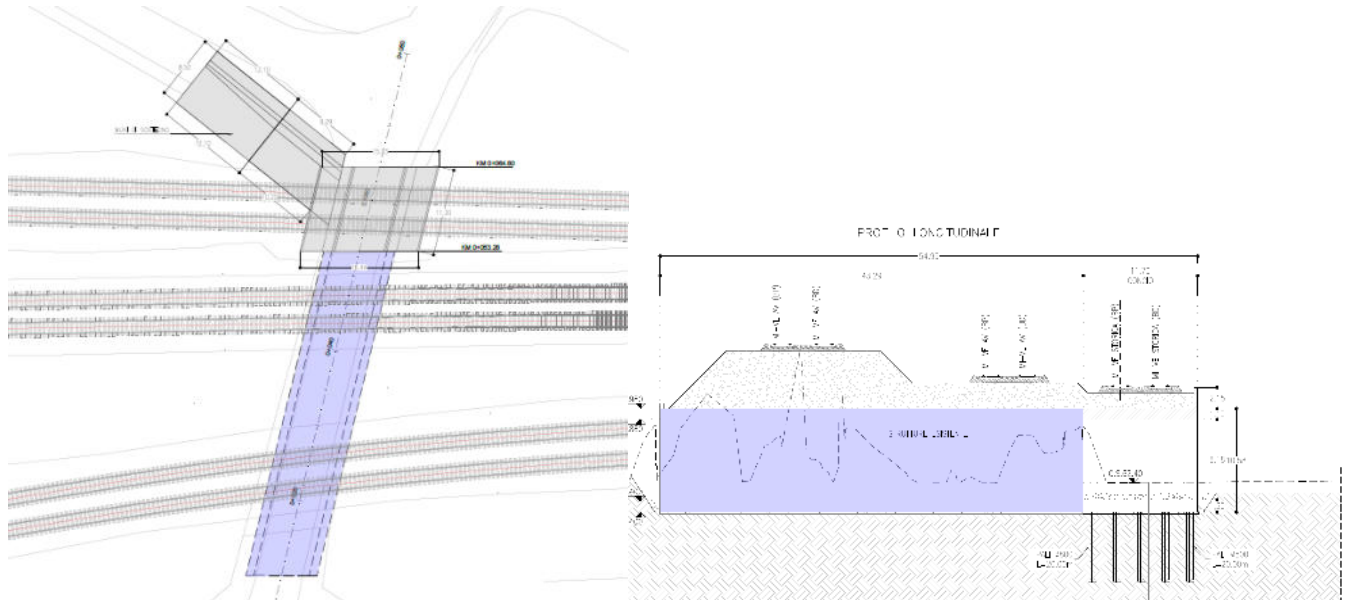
SL03 - Stralcio planimetrico e Profilo Longitudinale
